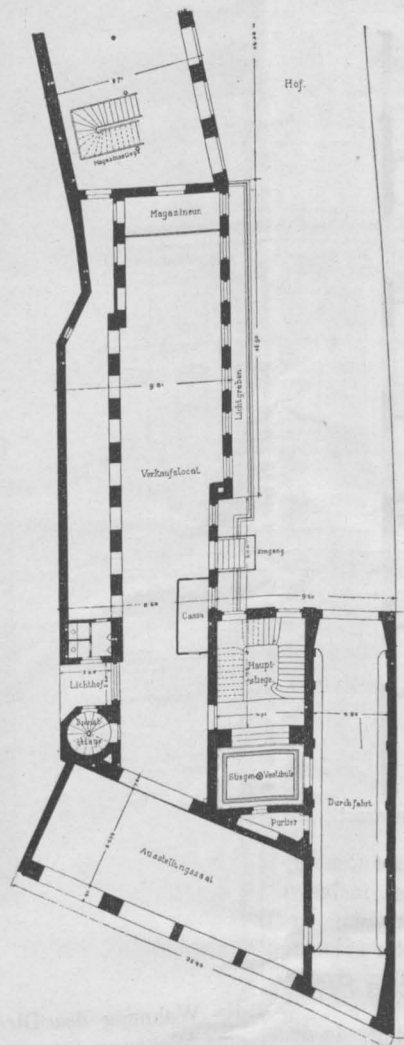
Parterre-Grundriss. 1:400.
